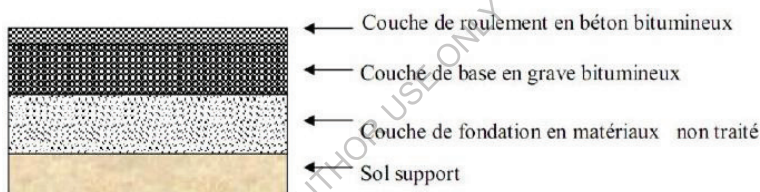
Modèle d'une chaussée souple (LCPC, SETRA, 1998).
